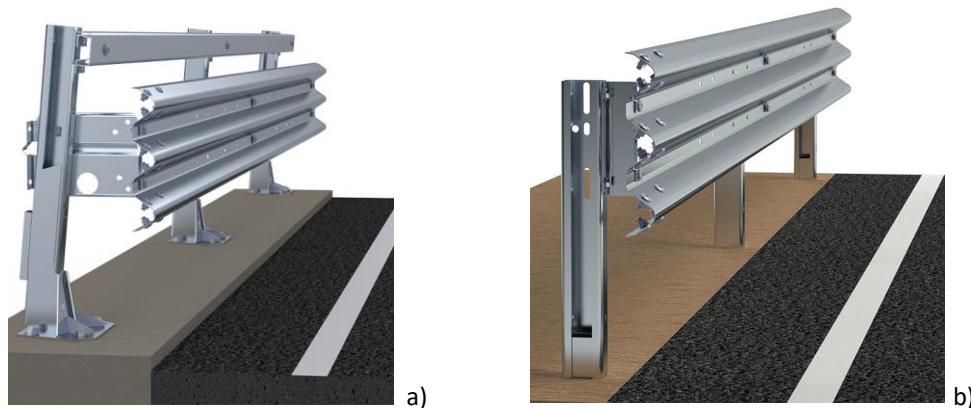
Guardrail: a) ancorato su cordolo in c.a. b) infisso nel terreno
